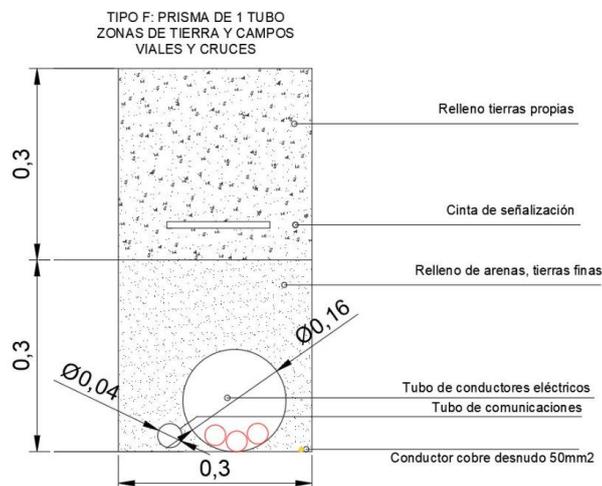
Sección tipo F de llegada y salidas de la LSAT a los registros Norte y Sur de la galería existente. Fuente: Proyecto Separata 2
